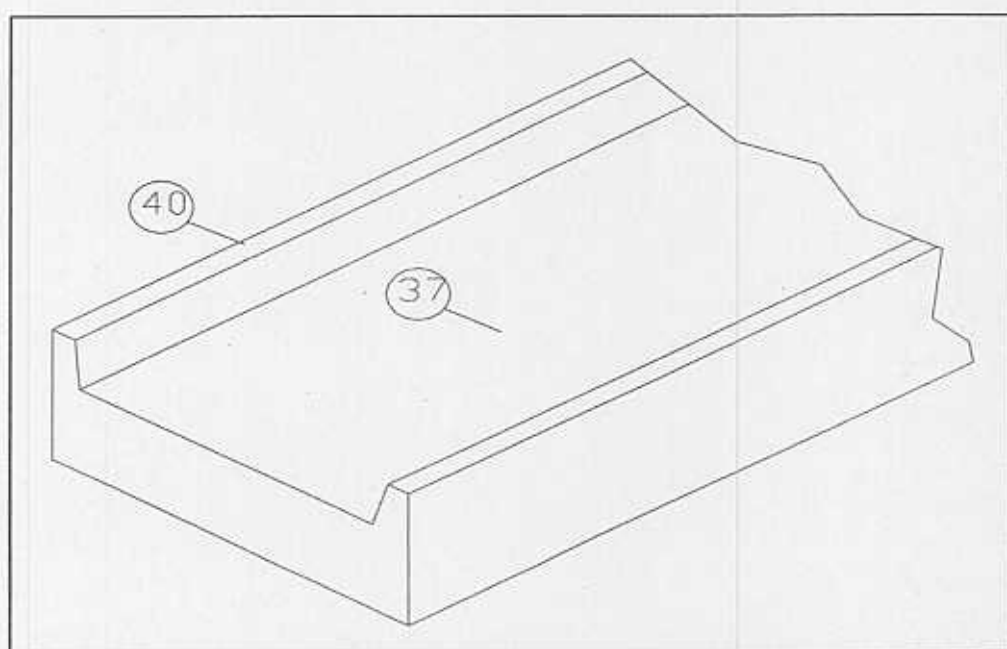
สะพานชนิด Deck Plate Girder
